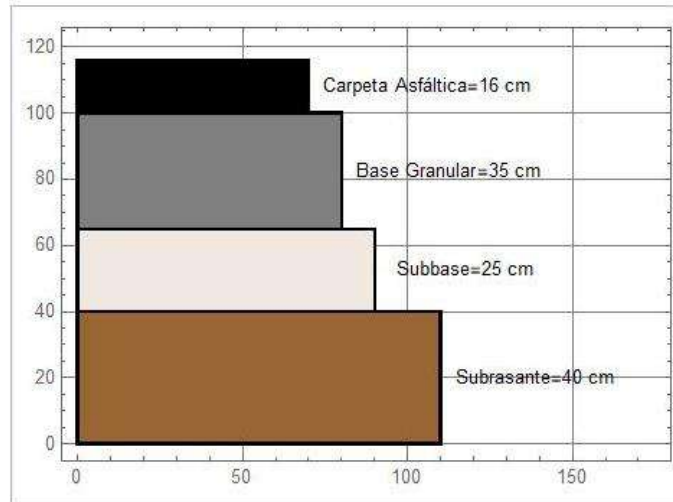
Alternativa de Estructura de Pavimento Flexible.
